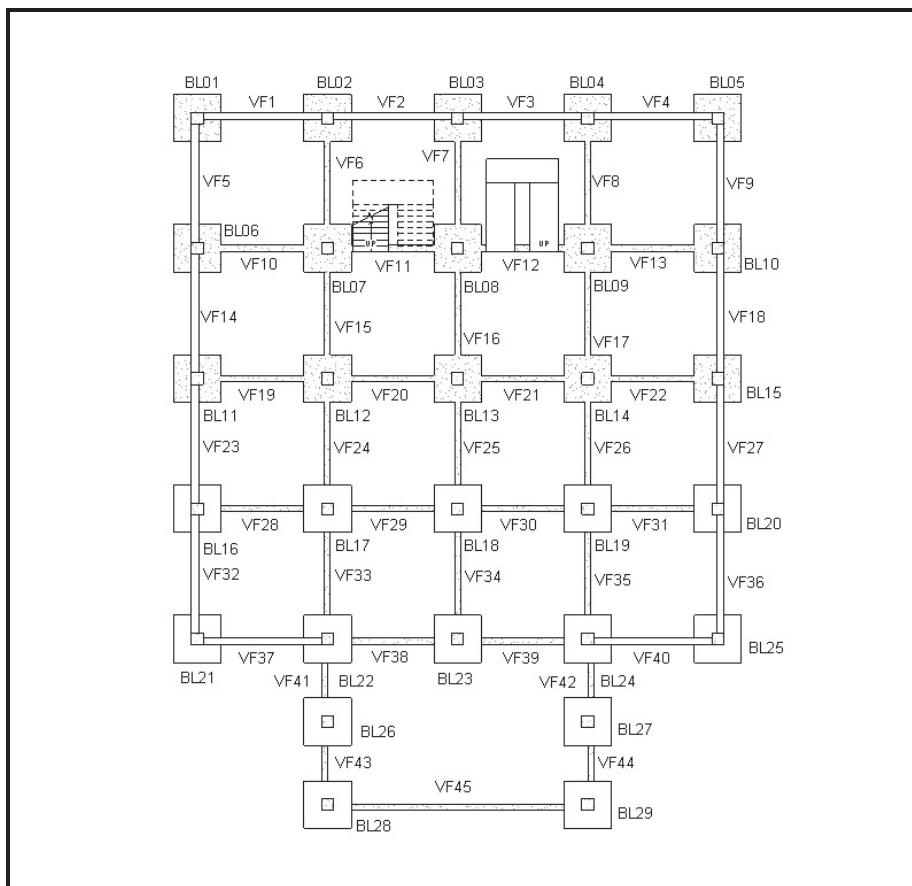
MODELO REVIT ARCHITECTURE 2011 – PAVIMENTO TÉRREO
